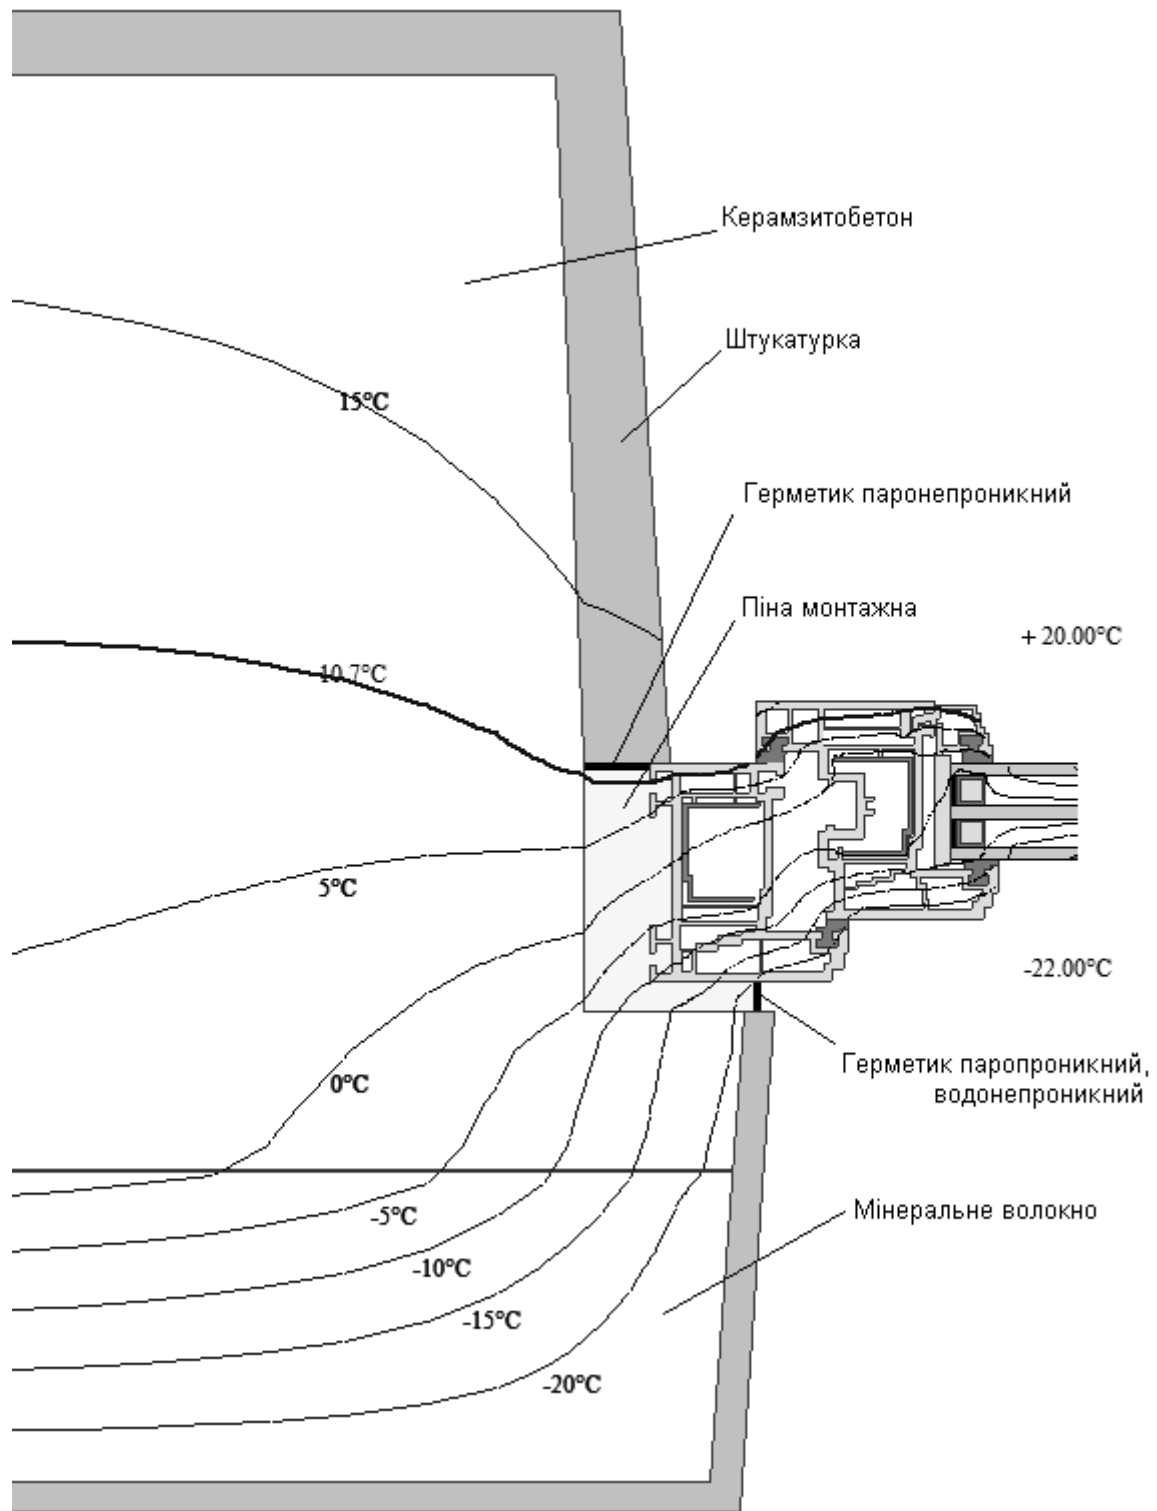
Узел бокового примыкания оконного блока из ПВХ профилей к стеновому проему с четвертью к стене из легкого бетона (керамзитобетон) толщиной 350 мм с внешним утеплителем из минеральной ваты толщиной 100 мм
